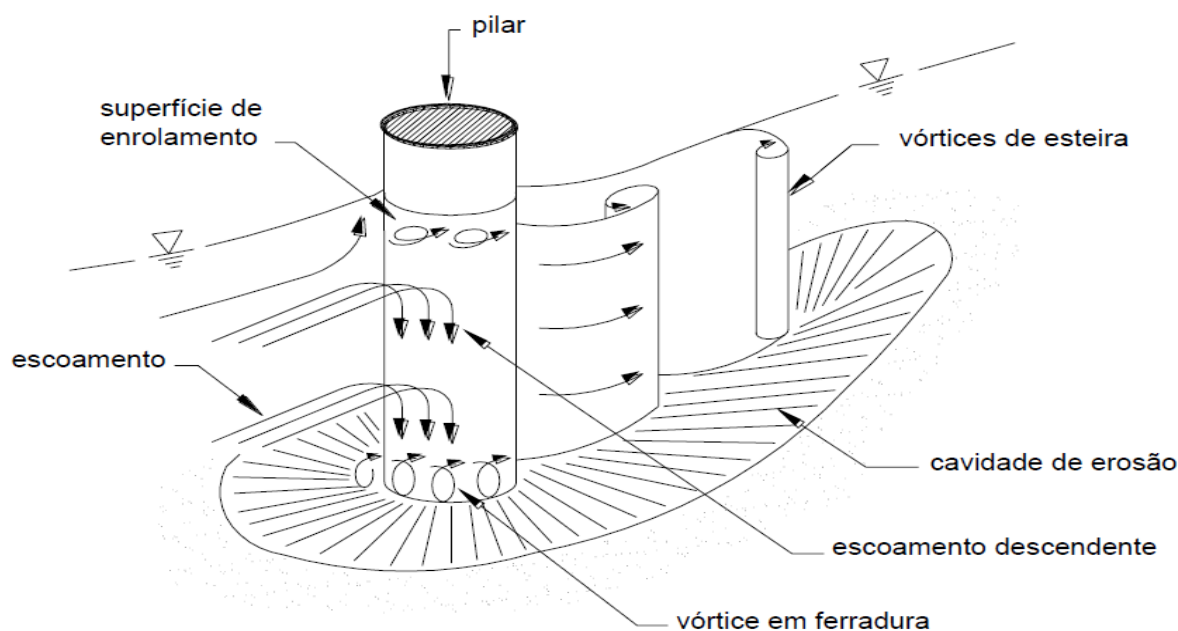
Estrutura do escoamento na proximidade de um pilar cilíndrico (Adaptado de [3])
